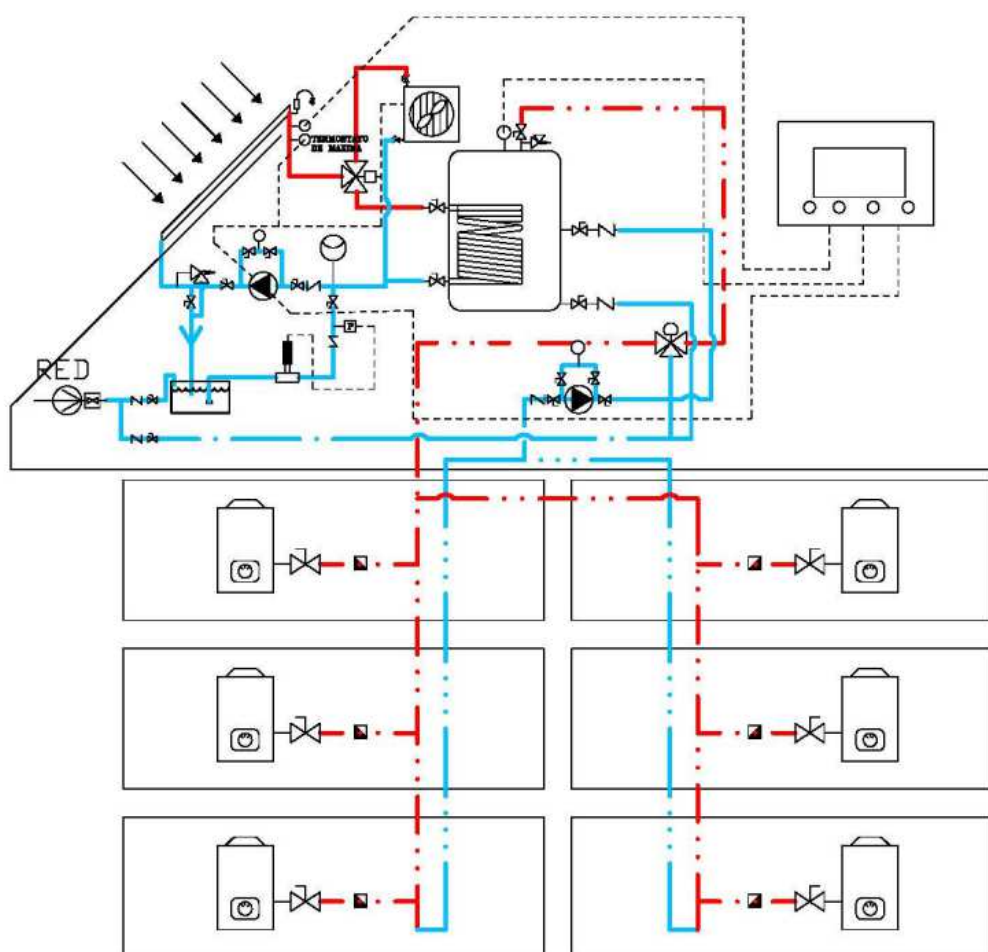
Sistema apoyo descentralizado para la producción de ACS<sup>37</sup>
